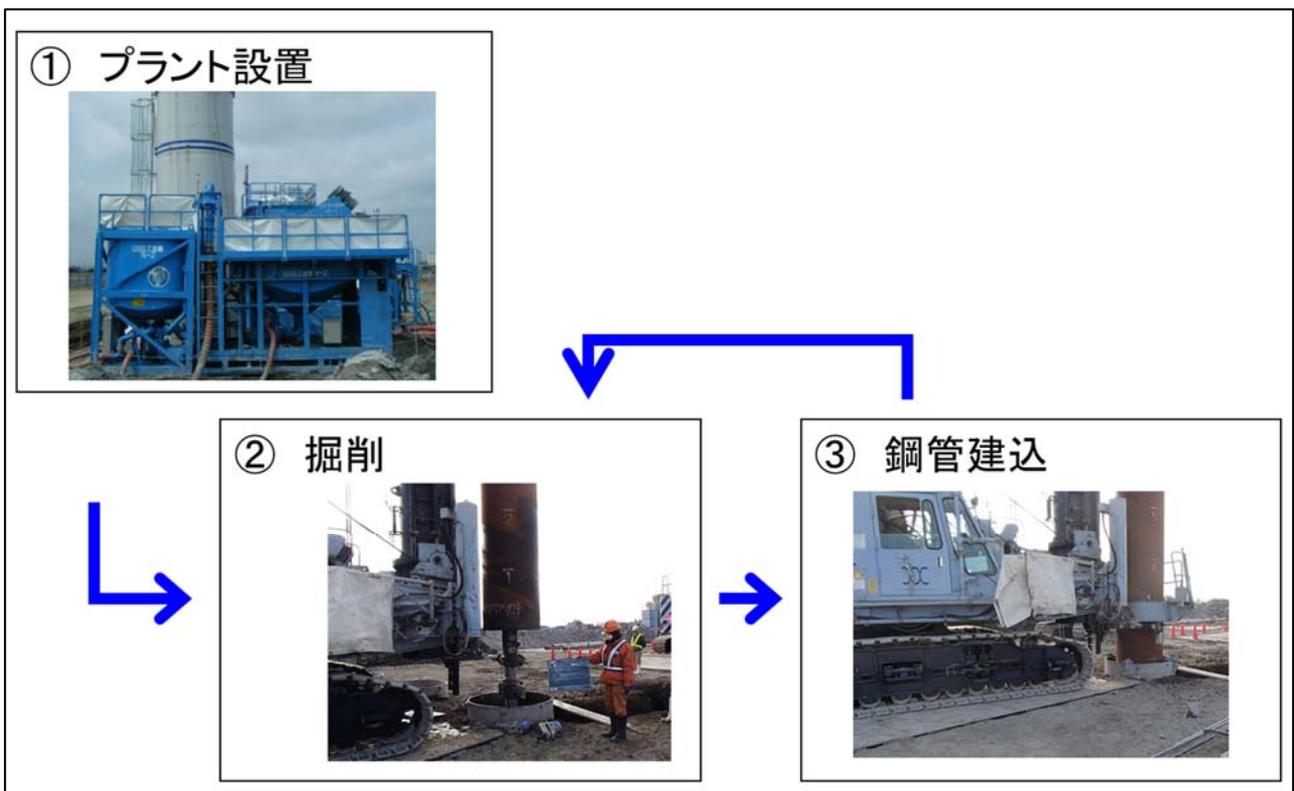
(3) 仮受杭工の施工手順（写真は類似工事の例）
